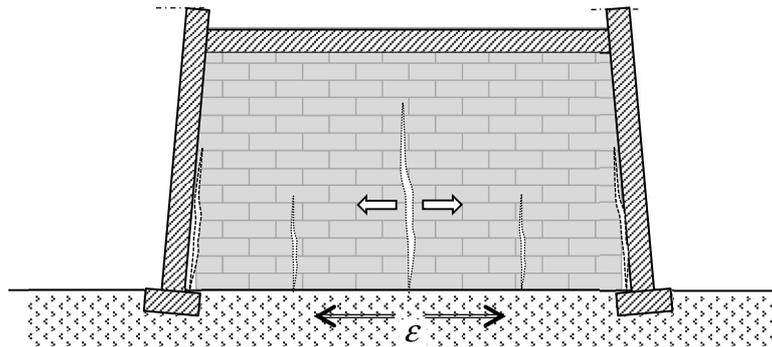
Exemple de fissures verticales induites par la déformation horizontale du terrain
